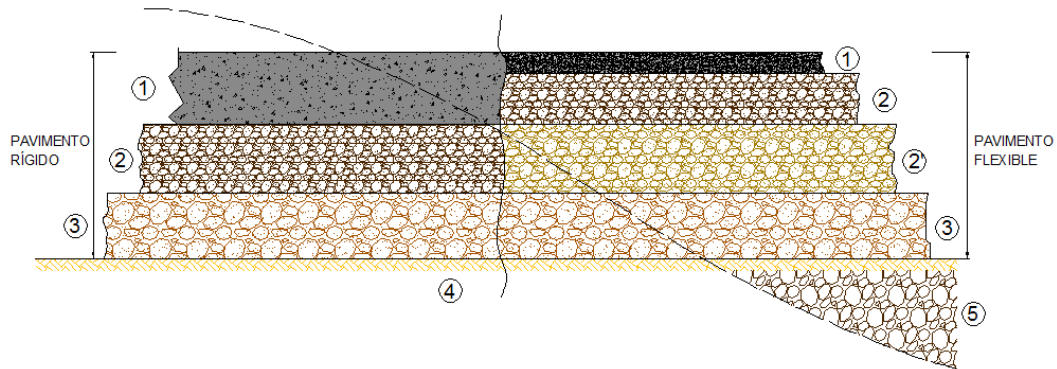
Estructura de los Pavimentos Flexibles y Rígidos.
